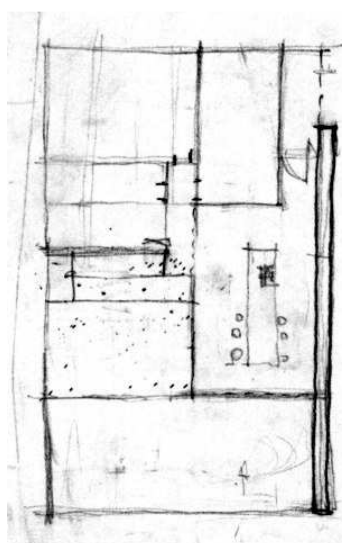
Planta com área unificada no lado da elevação dos fundos
